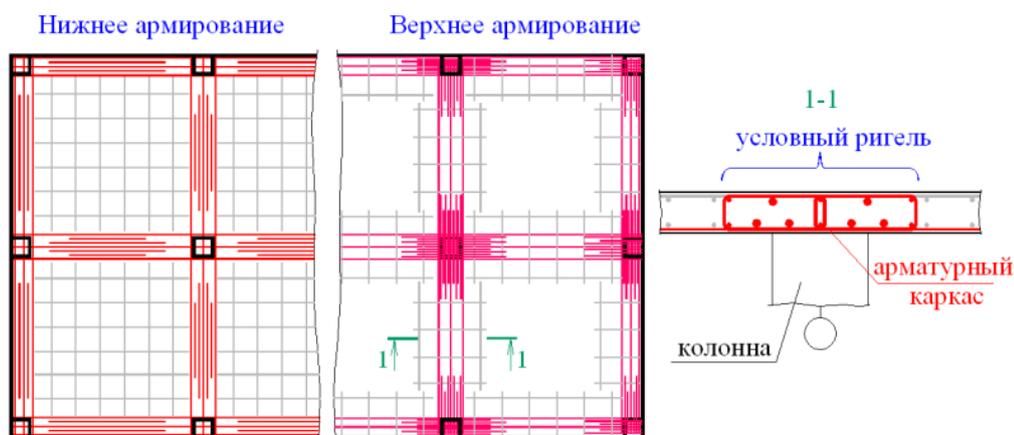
Концентрированное «ригельное» армирование плоских плит пространственными каркасами
